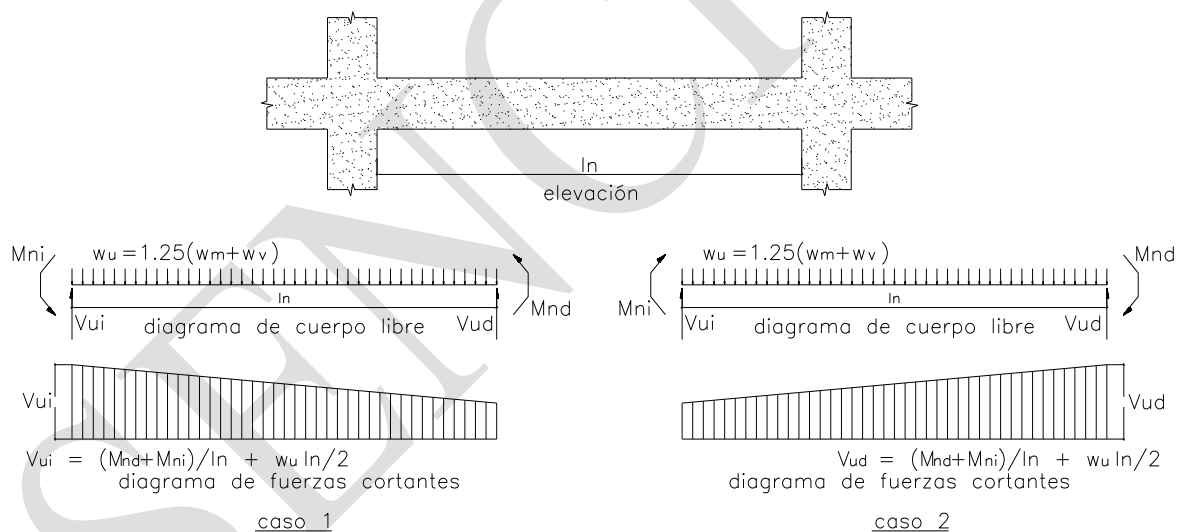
Fuerza cortante de diseño en vigas
